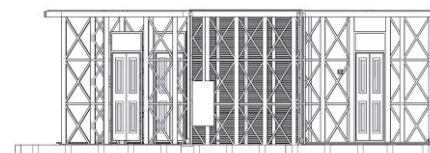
Vista Lateral Direita com corte , vista do corredor , apartamento sem paredes exteriores, em corte vertical , expondo tipo construtivo, criação do autor.
